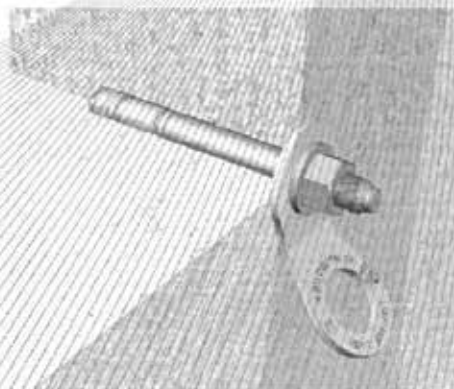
dispositivo di ancoraggio, tipo LUX-top® EASY, montato su calcestruzzo
